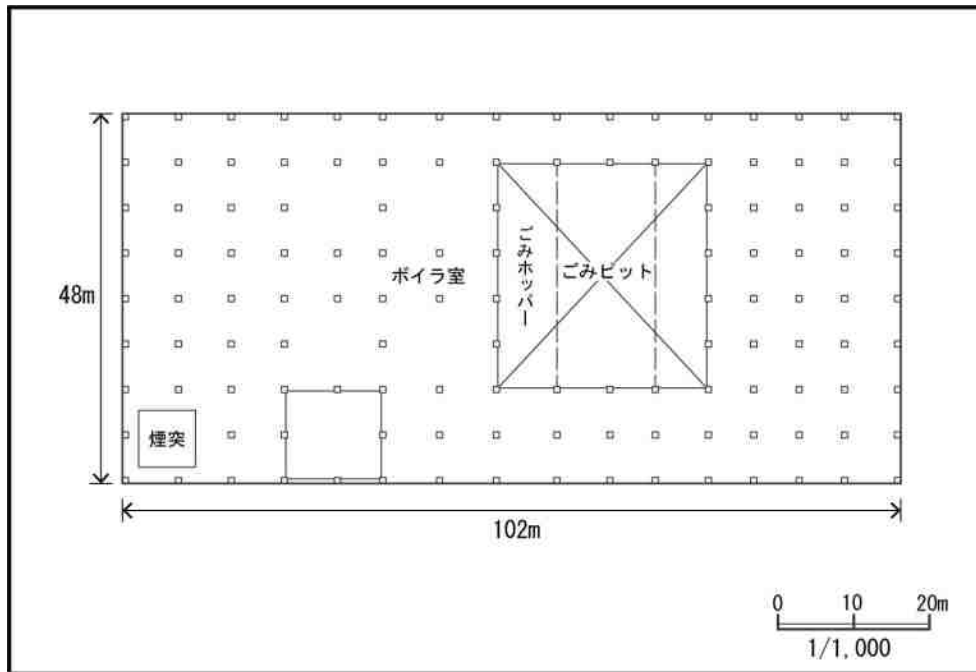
(7) 新施設の平面図（新焼却処理施設 6 階）
